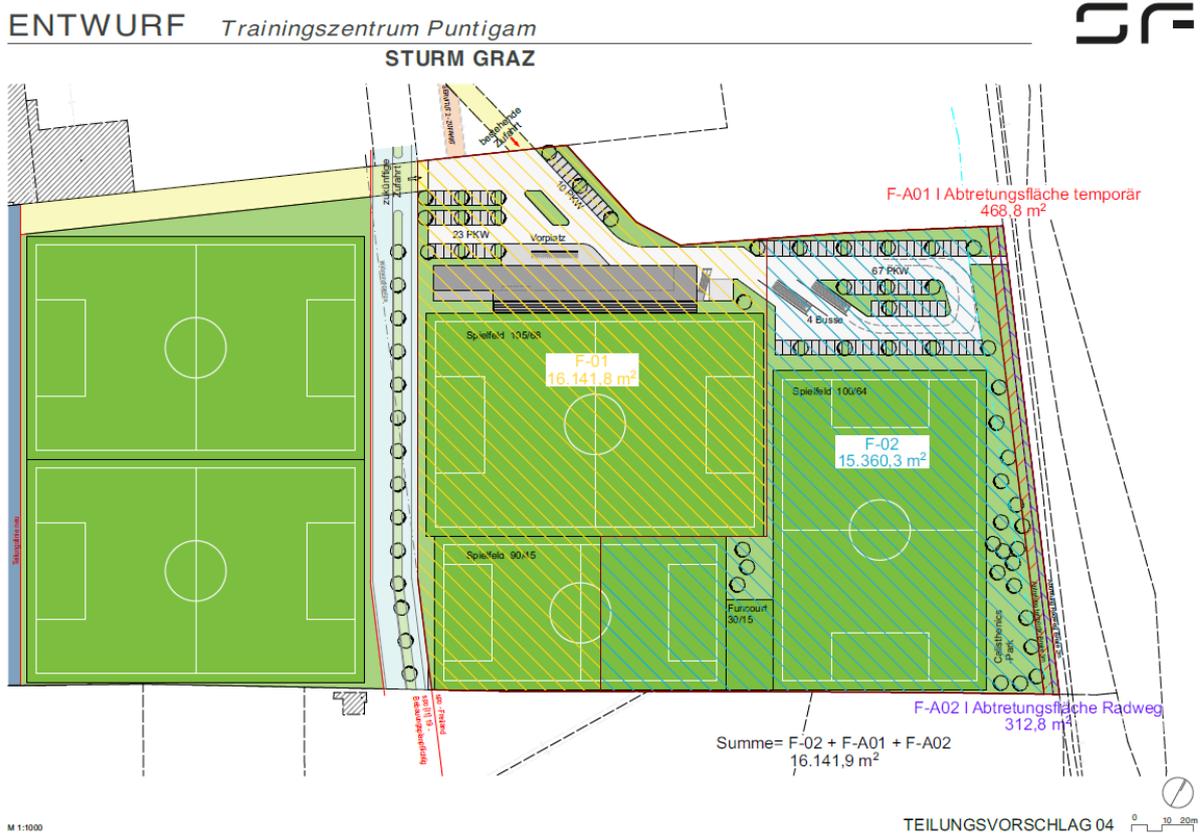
Ausschnitt Entwurfsunterlage neues Sturm-Trainingszentrum
